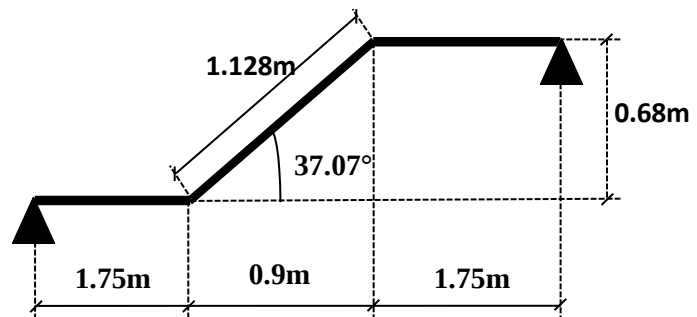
Schéma statique de la poutre brisée sur l'escalier.
